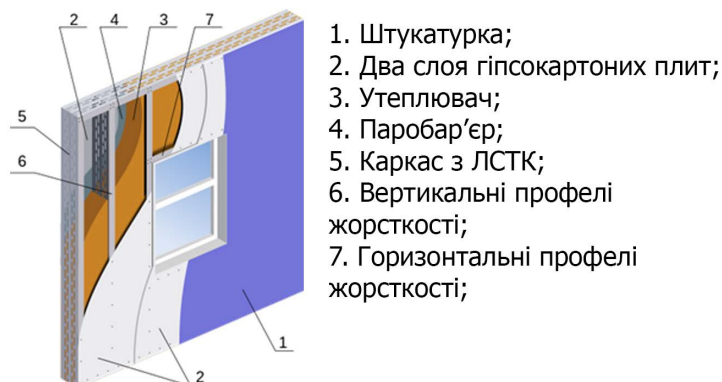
Схема каркасу ЛСТК з мокрым фасадним оздобленням
